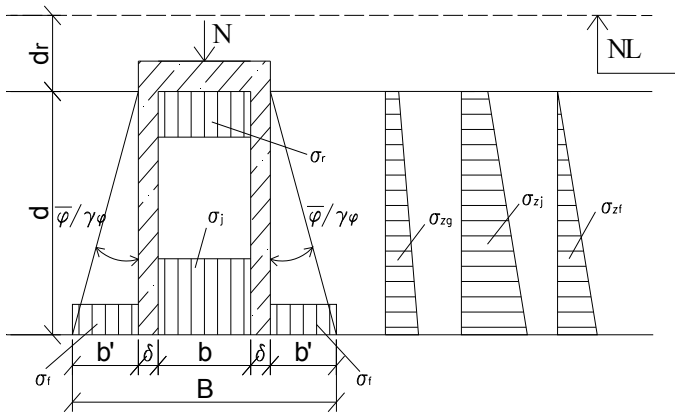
Схема к определению осадки верхнего слоя s_b
